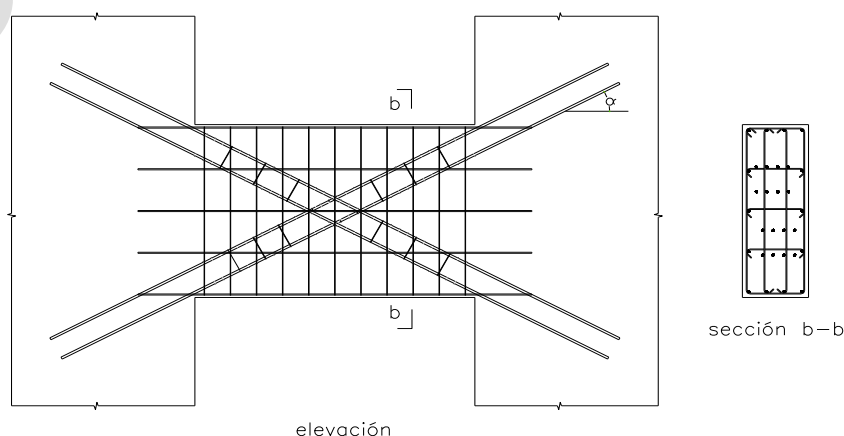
ii Refuerzo alternativo de vigas de acople
